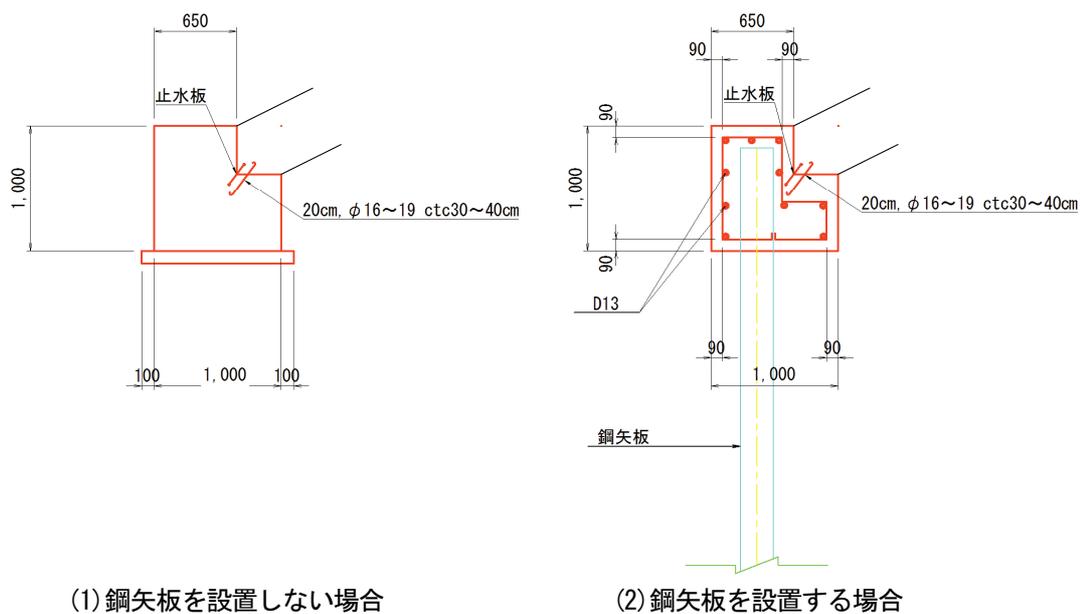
現場打ちコンクリート被覆の基礎形状
